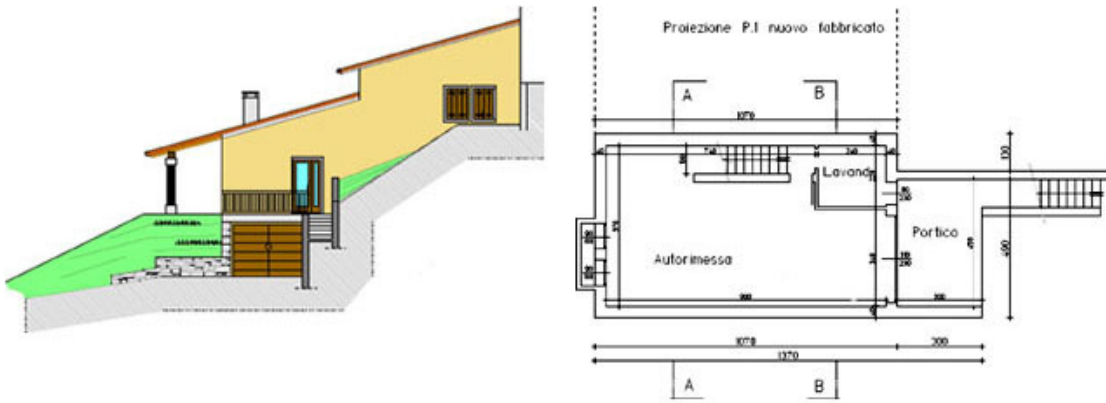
Prospetto ovest del fabbricato (a sinistra) e pianta del piano interrato (a destra).
